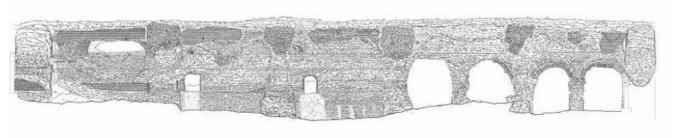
Alzado longitudinal Mura d'Arce en Palma Campania. Fuente: E. Cosimi 2008.
